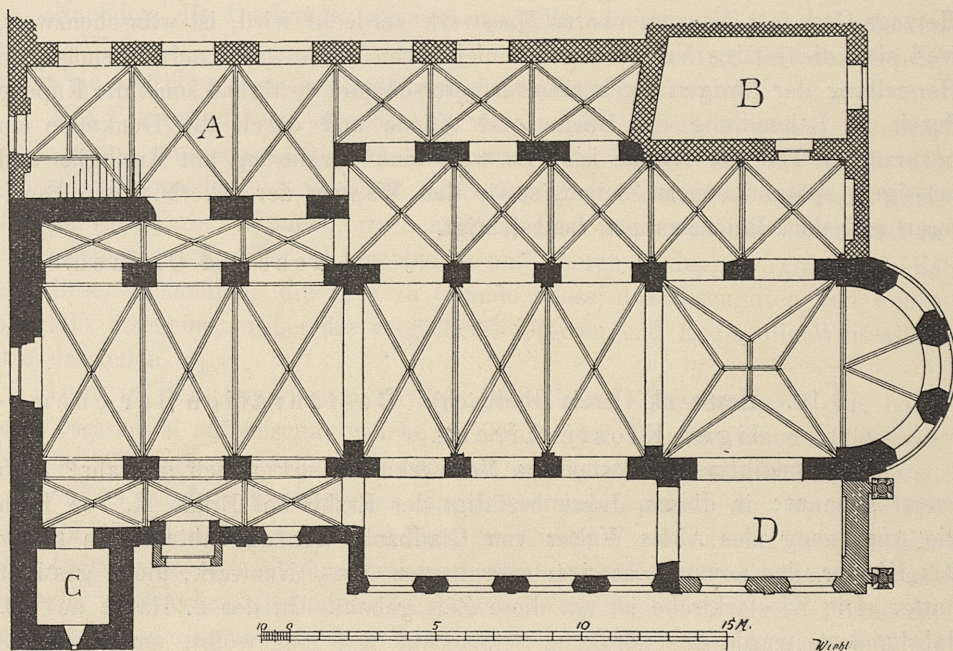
Neuwerk. Grundriss der Klosterkirche.
